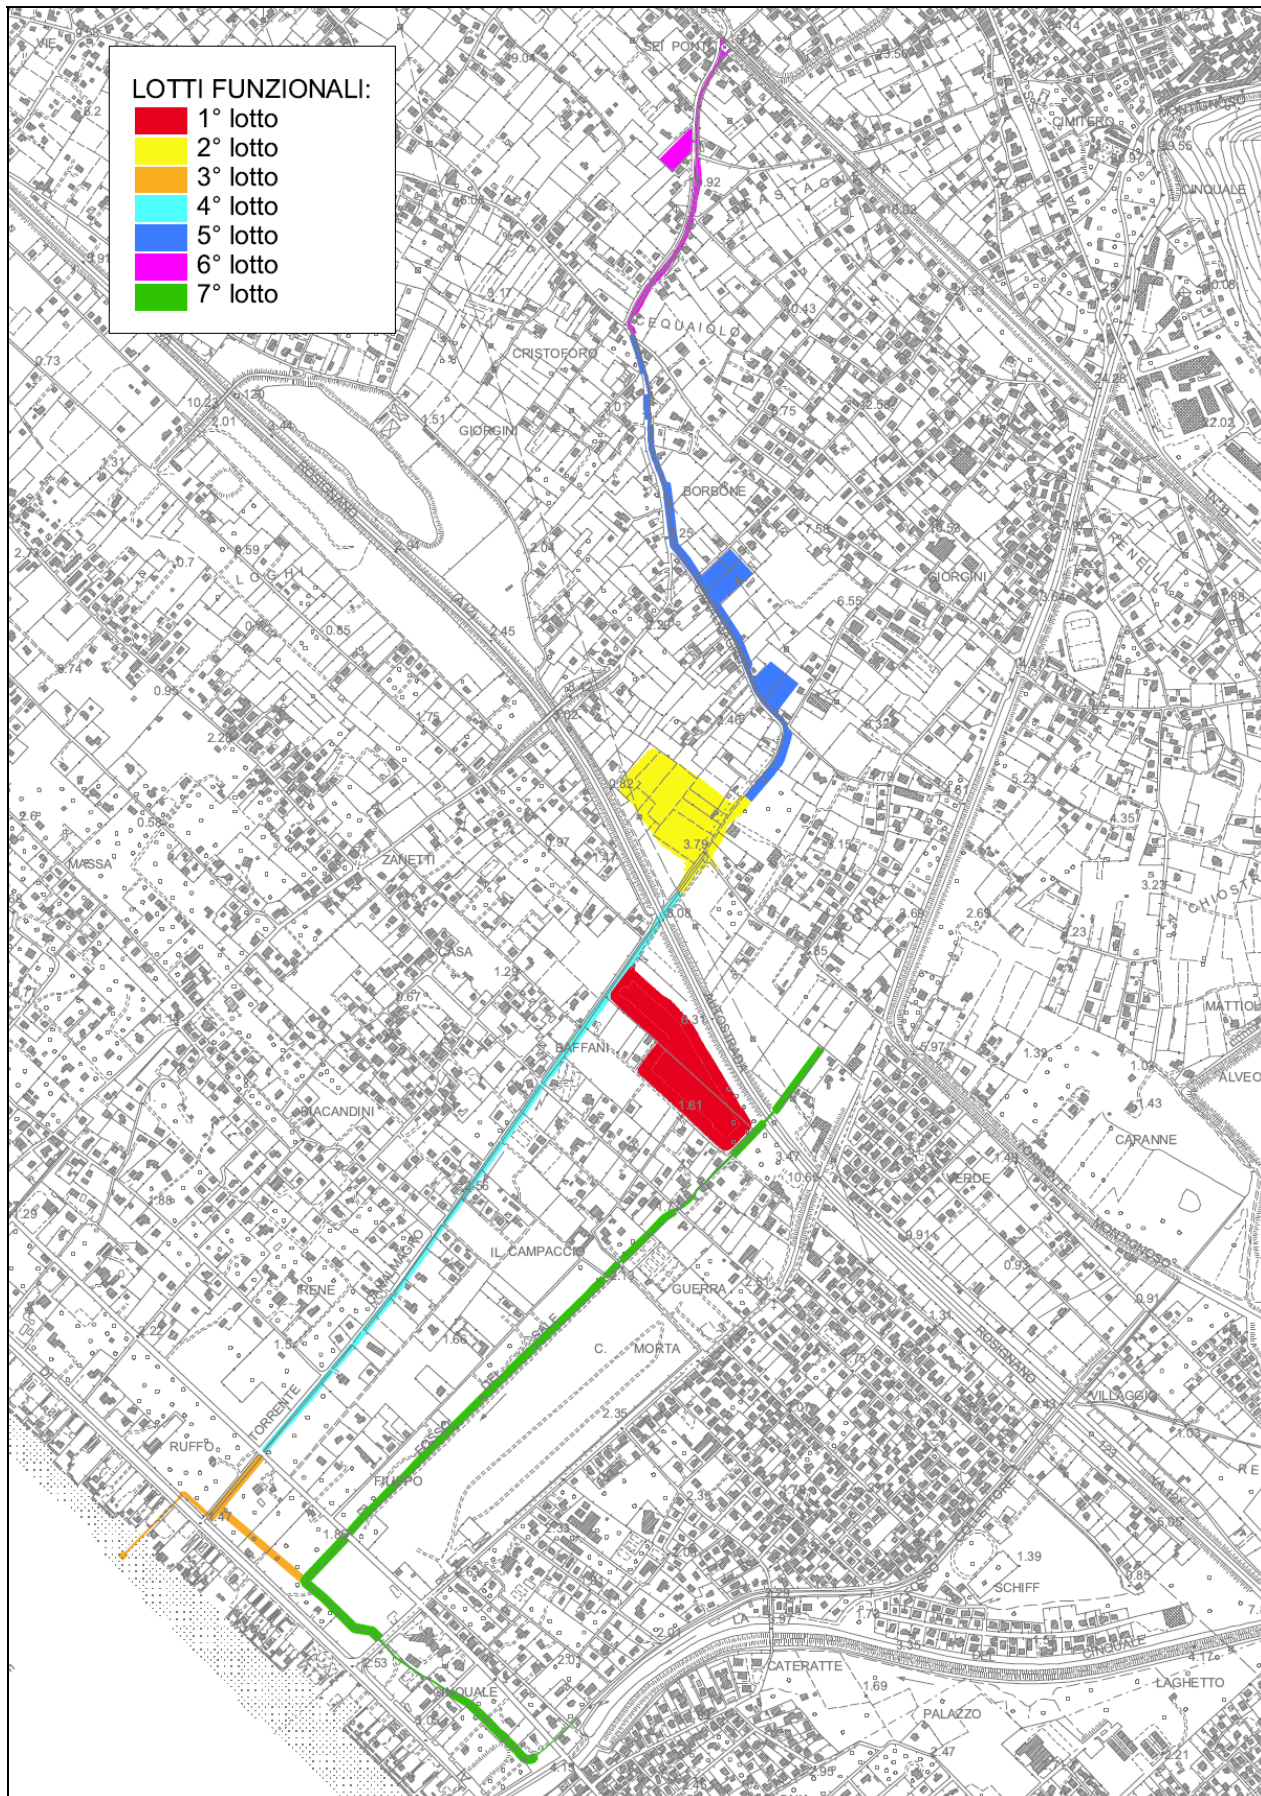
Suddivisione del progetto complessivo in lotti funzionali.
